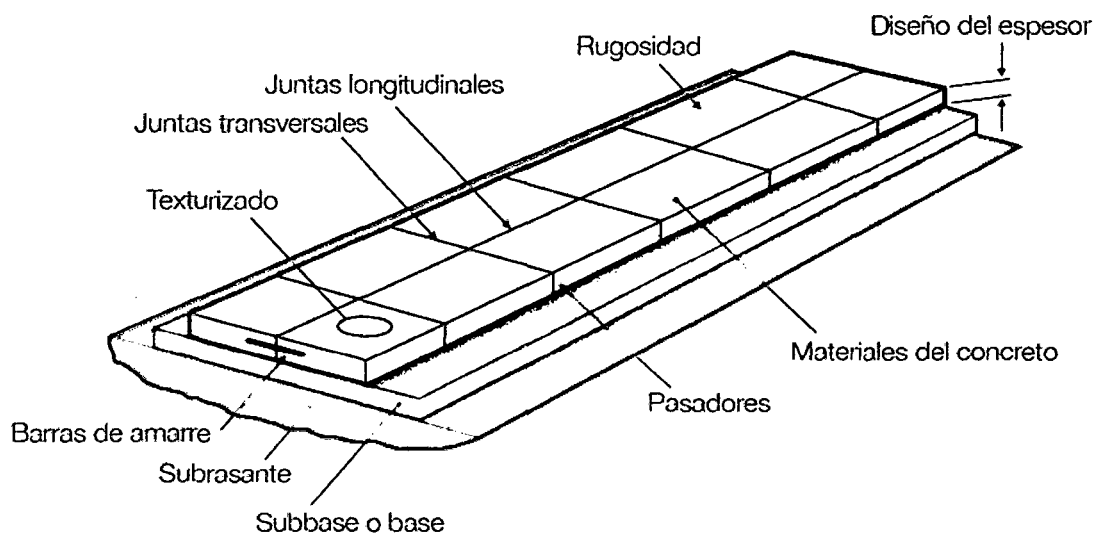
Elementos de un pavimento de concreto (DURAVIA 2012)
